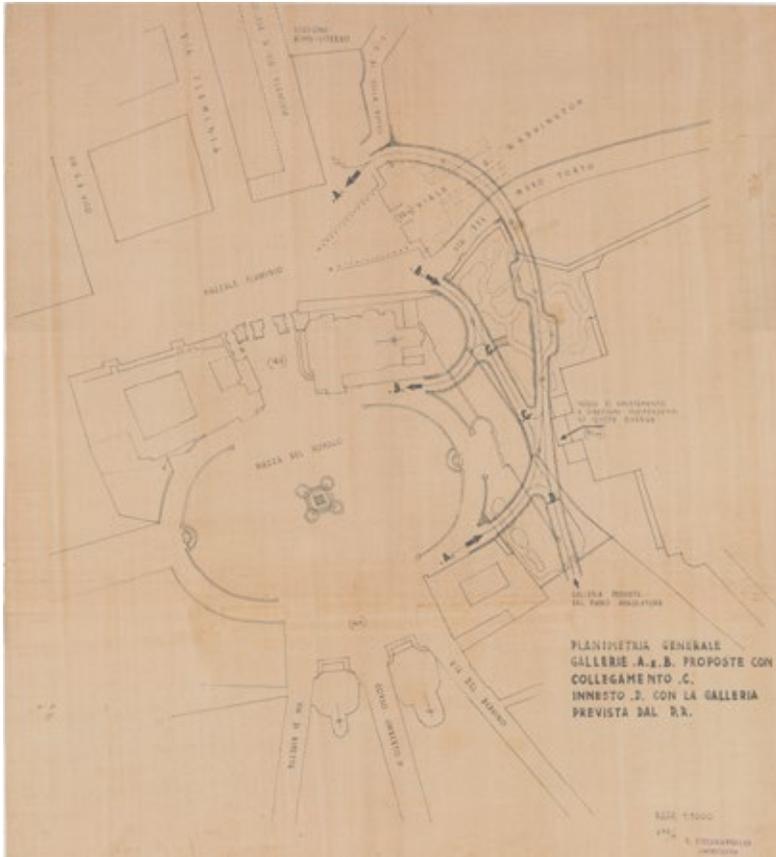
Roma, progetto di collegamento fra piazzale Flaminio - piazza del Popolo e innesto con la galleria prevista dal Piano regolatore, L. Chiaraviglio, planimetria generale, s.d. [post 1924], 1:1.000, copia eliografica, 43 x 44,5 (GG, c. 8.16, dis. 1).
